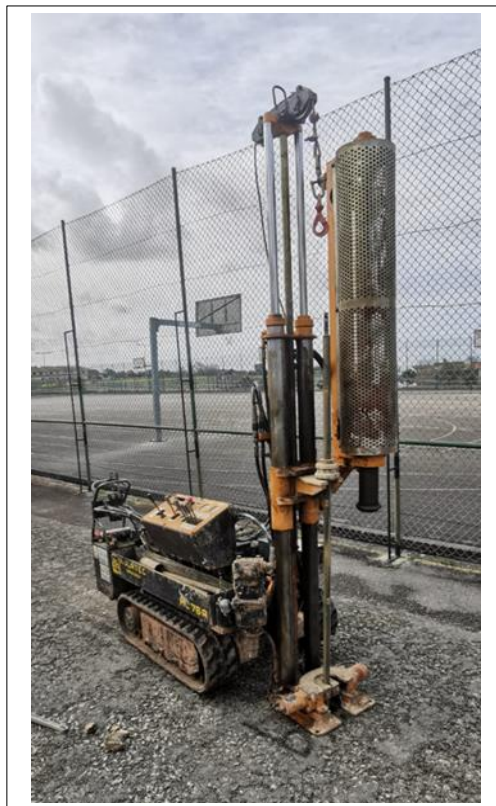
Fotografia da máquina para execução dos ensaios de DPSH.
